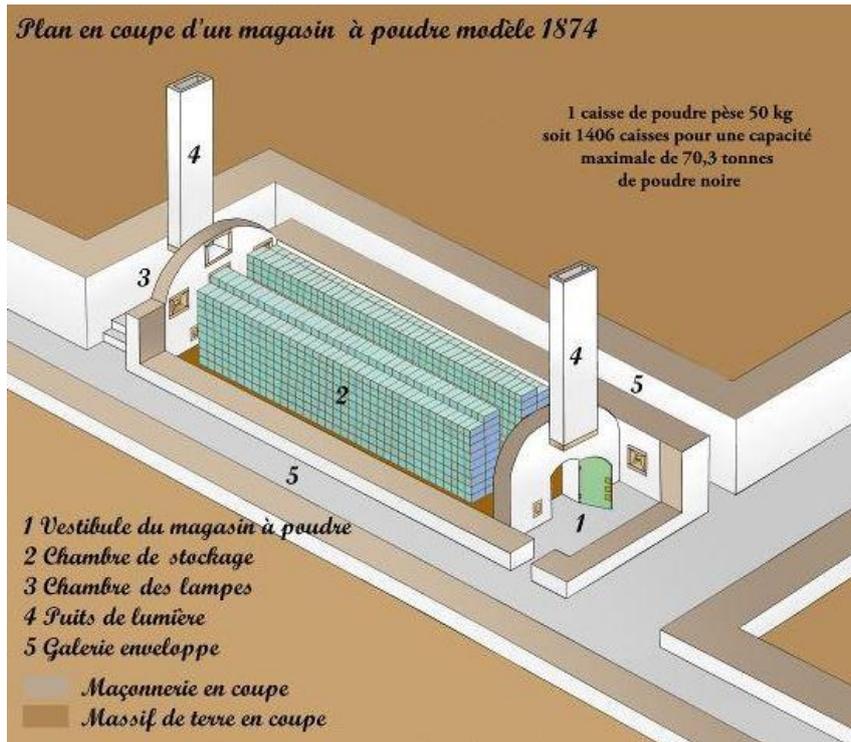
Plan en coupe d'un magasin à poudre model 1874
